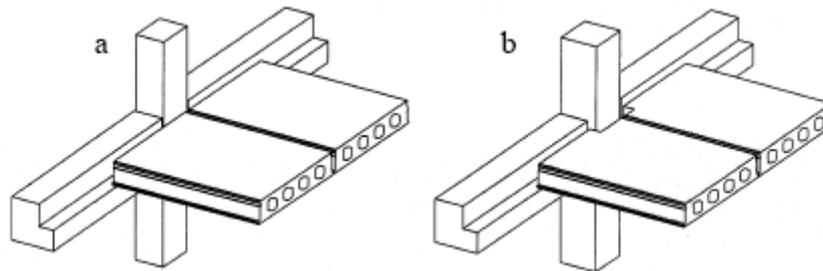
Point de rencontre des poutres de plancher et des colonnes
